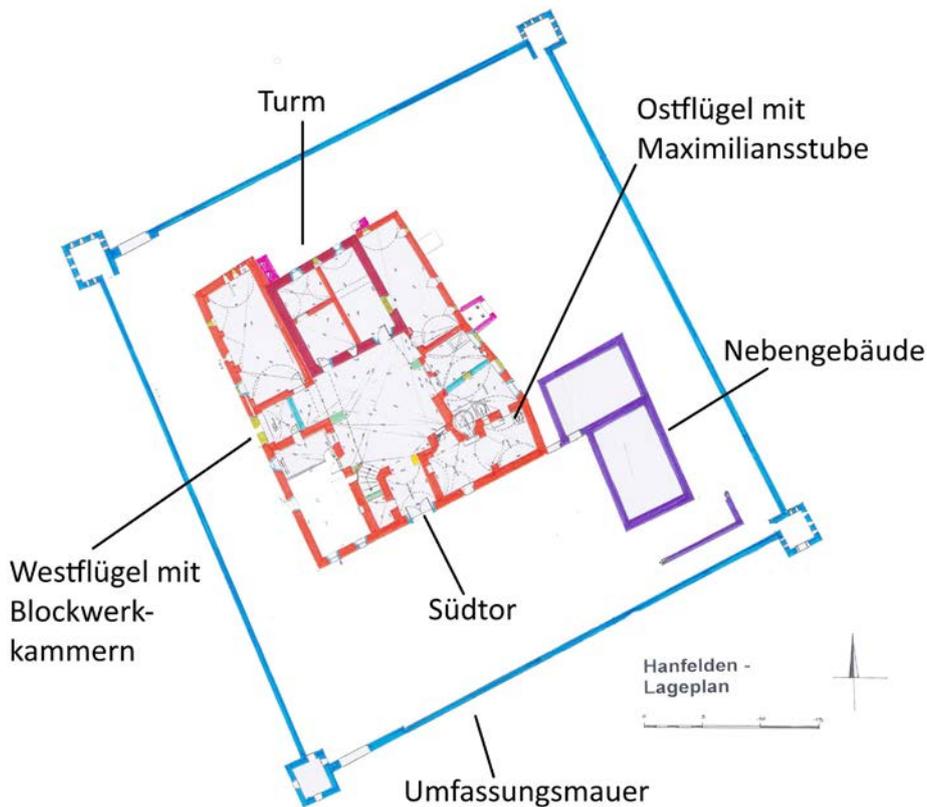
Schloss Hanfelden, Bauhistorischer Grundriss des heutigen Baubestandes (M. Aigner 2002)
